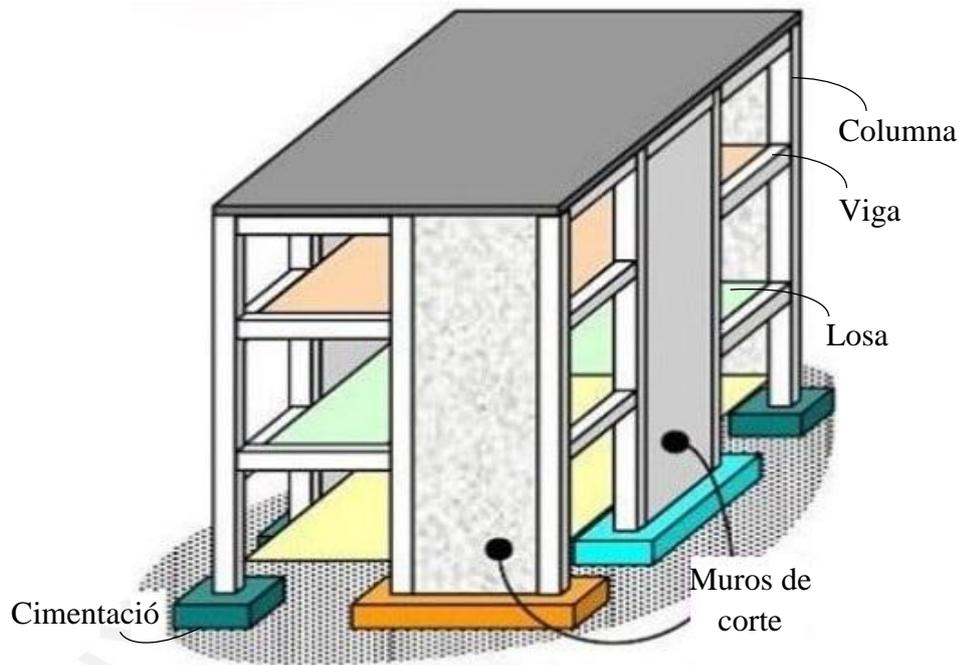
Elementos estructurales en un sistema dual [13]
